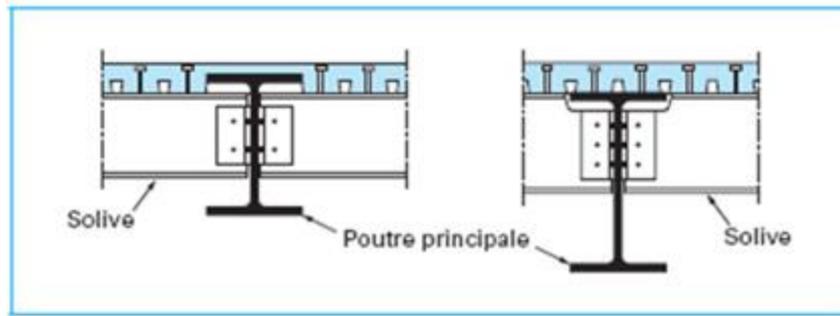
Assemblages de type poutre-poutre de plancher mixte
